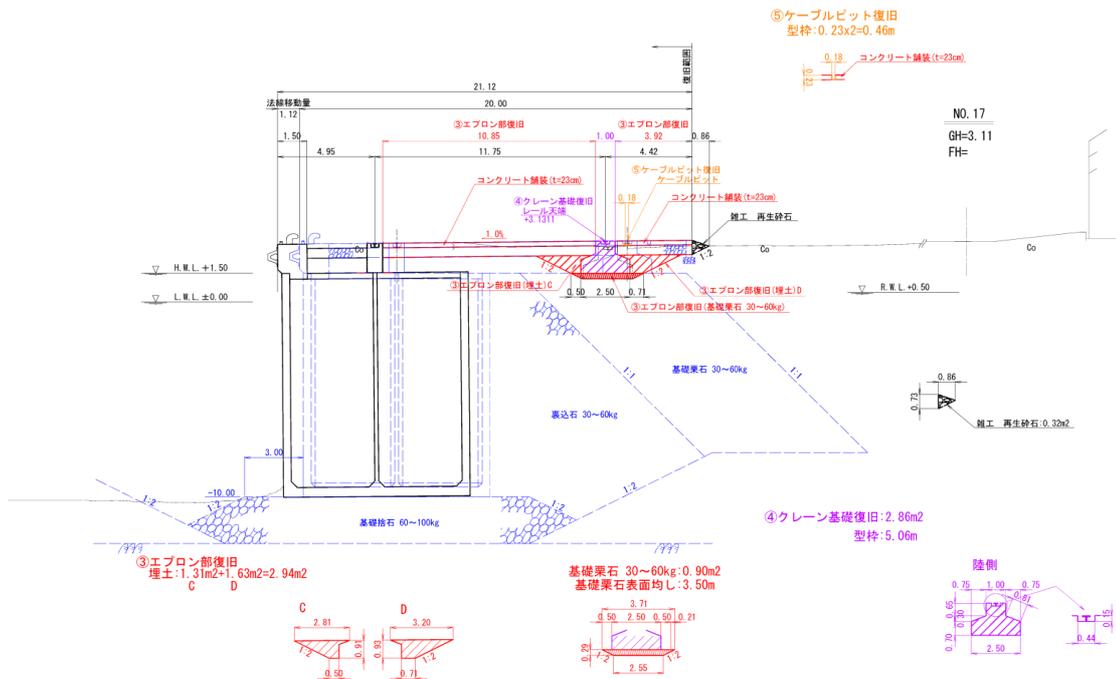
No.4 日立港区_第1ふ頭地区 1-D 岸壁 (-10.0m) の断面図 (復旧後)
